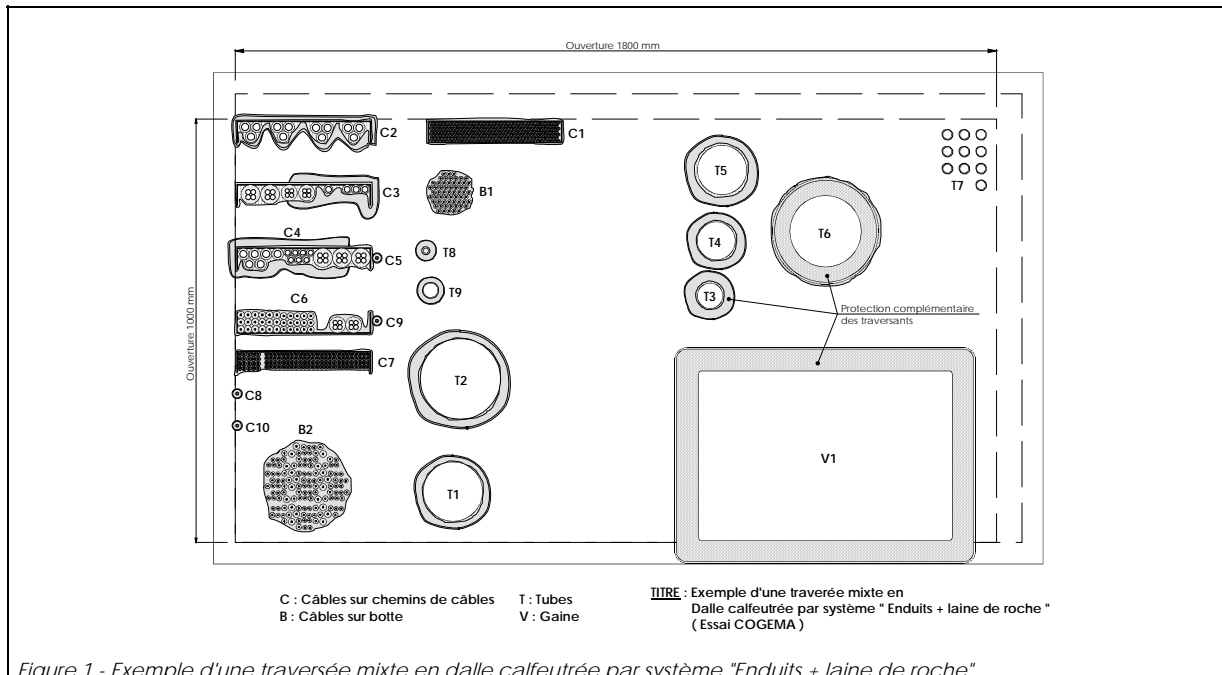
Exemple d'une traversée mixte en dalle calfeutrée par système "Enduits + laine de roche"
